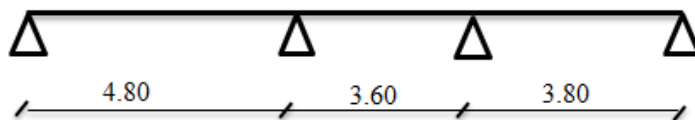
Poutrelle type 05 (Plancher RDC et étages courants)
